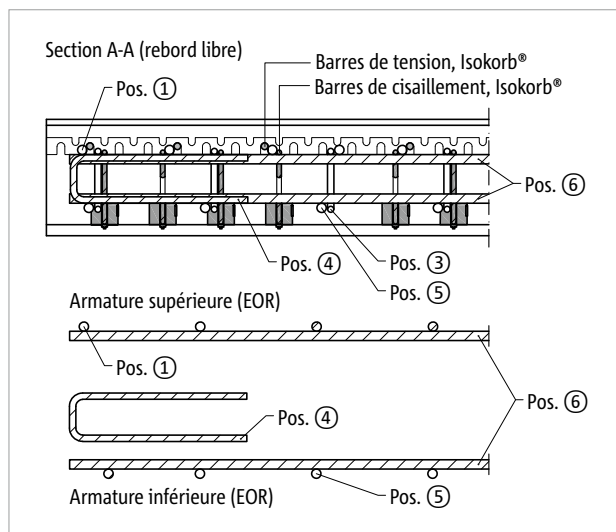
Schöck Isokorb® T Type CK : section A-A Illustration d'un bord de balcon libre
